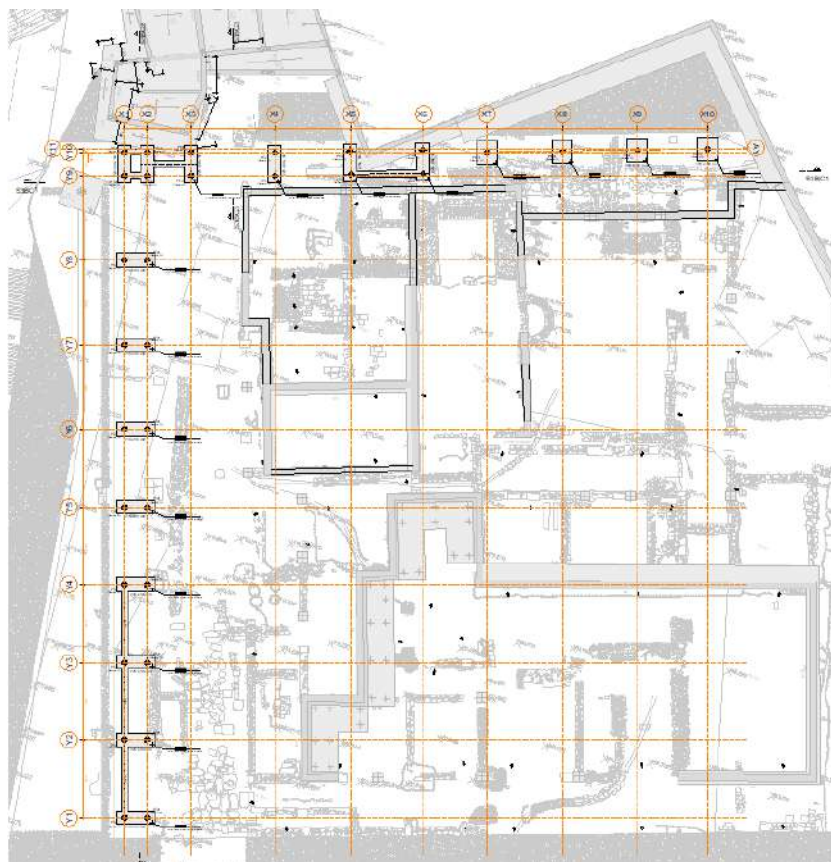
S3B - Planta de Fundações Percurso Exterior
